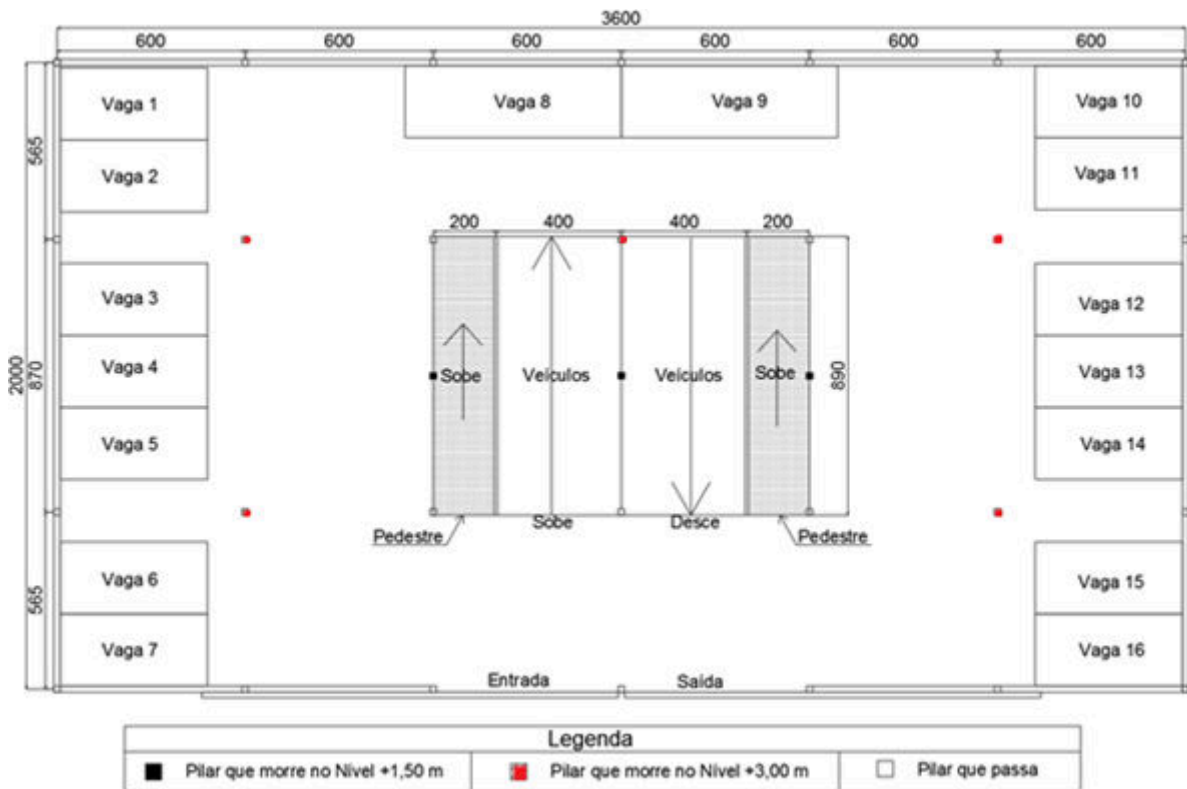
Arquitetura – Planta Baixa do Térreo, nível +0,00 m.
